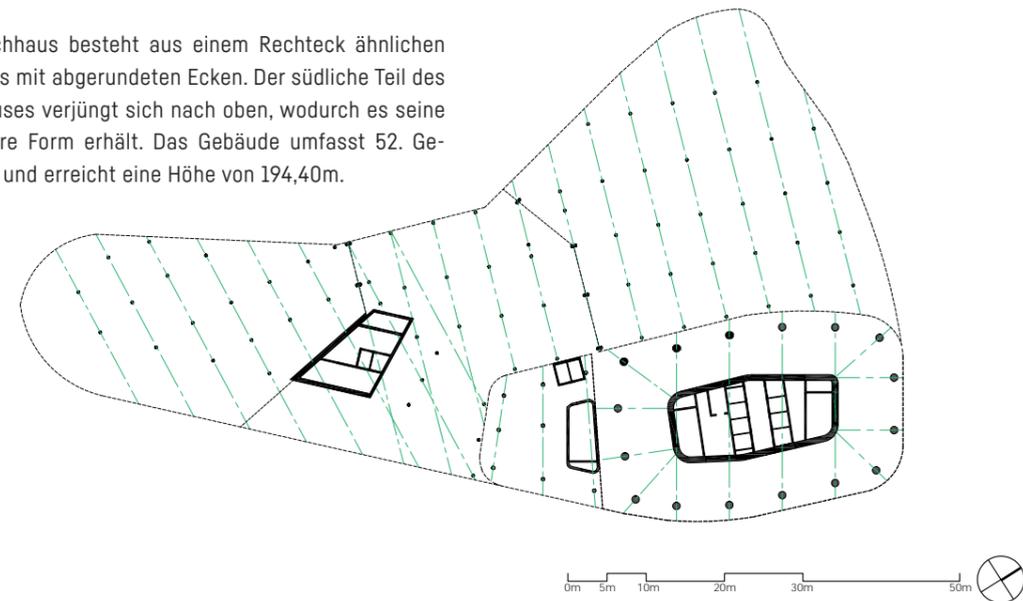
Grundriss des Tragsystems: Achsenraster und aussteifende Kerne
